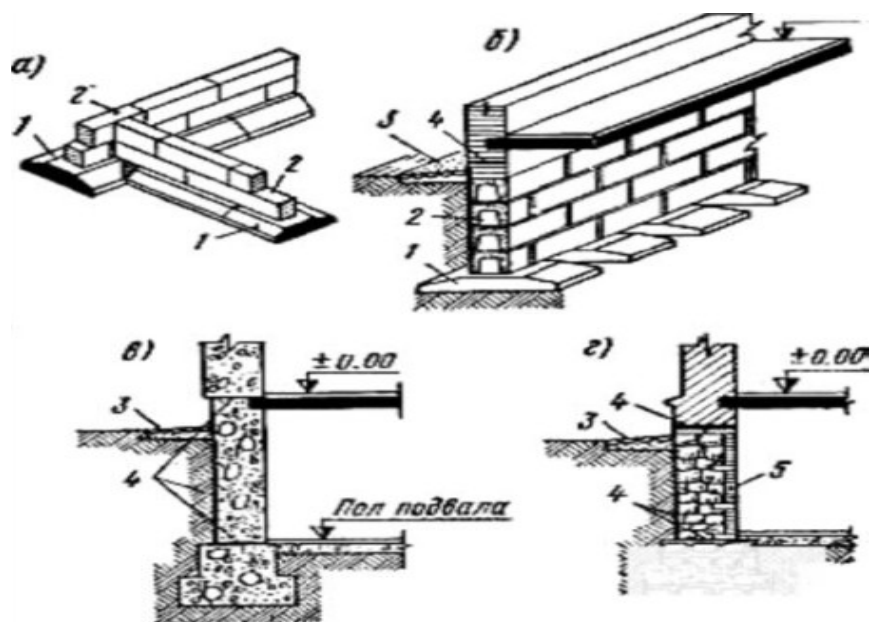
Конструкции ленточных фундаментов: *а* — сборный; *б* — то же, прерывистый; *в* — монолитный фундамент (бутобетонный); *г* — бутовый фундамент: 1 — фундаментные подушки; 2 — бетонные блоки; 3 — отмостка; 4 — гидроизоляция; 5 — кирпичная облицовка (в полкирпича)
